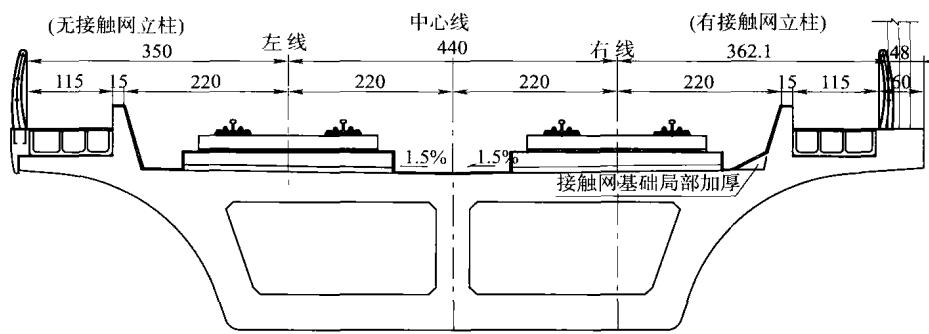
广珠城际铁路箱形梁横断面示意(单位:mm)
